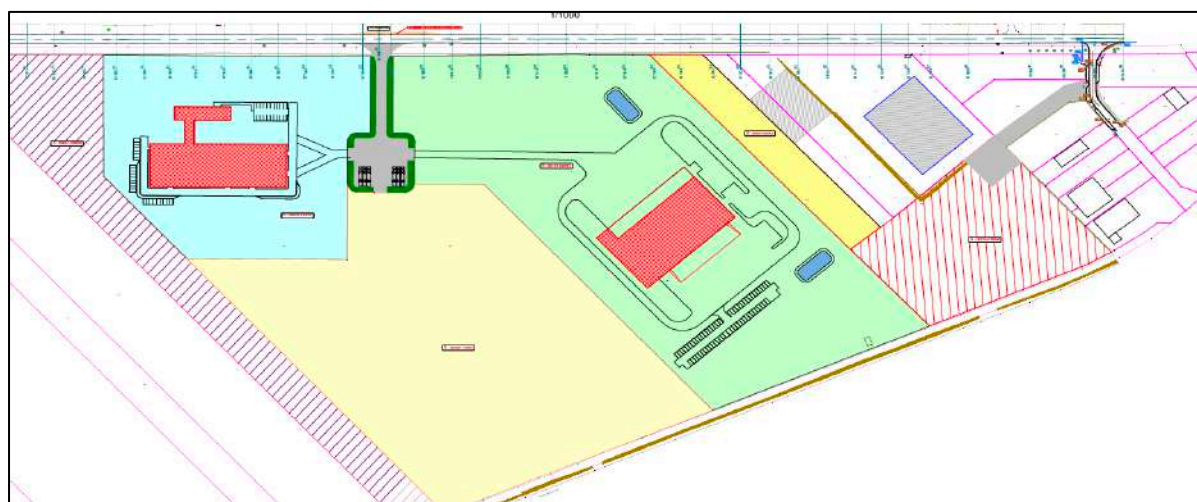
Plan APS 2 (accès central) - (Source : Châlons Agglomération)
